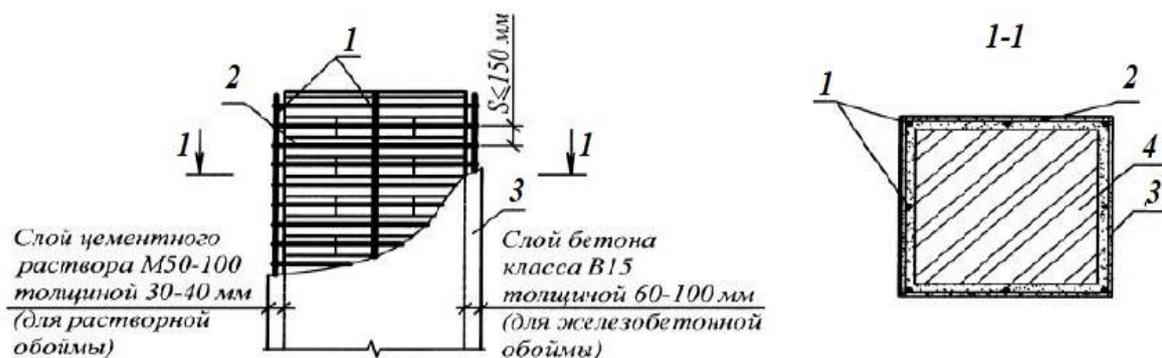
Усиление капитальных стен с помощью железобетонной рубашки: 1 — вертикальная арматура; 2- сварные хомуты; 3 — железобетонная обойма; 4 — усиливаемая конструкция
